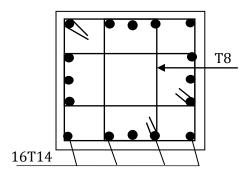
Schéma de ferraillage des poteaux 6éme, 7éme étage.
